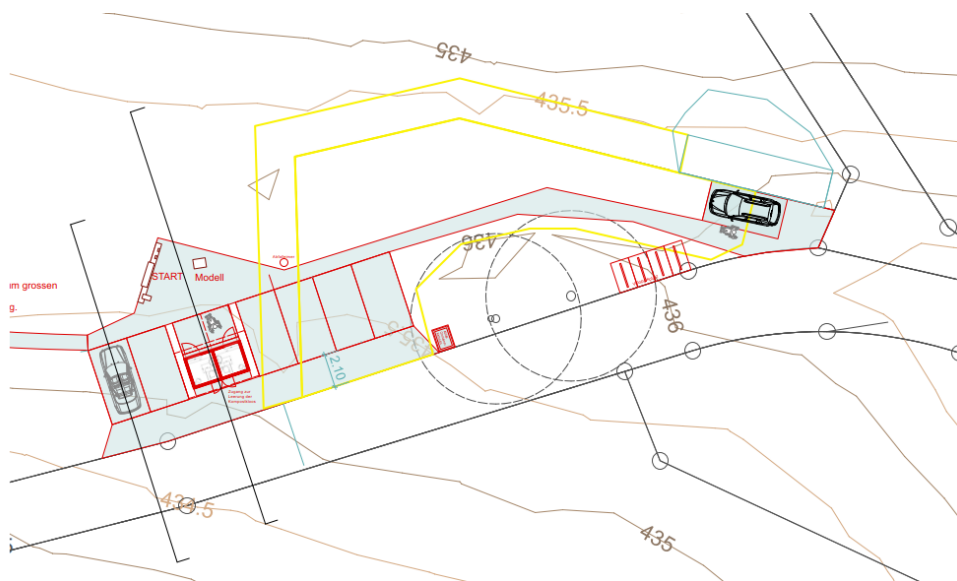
Grundriss Parkplatz (Stand 25.2.2025), gelb: Abbruch, rot: Neue Elemente (Quelle: Kantonsarchäologie Zürich)
